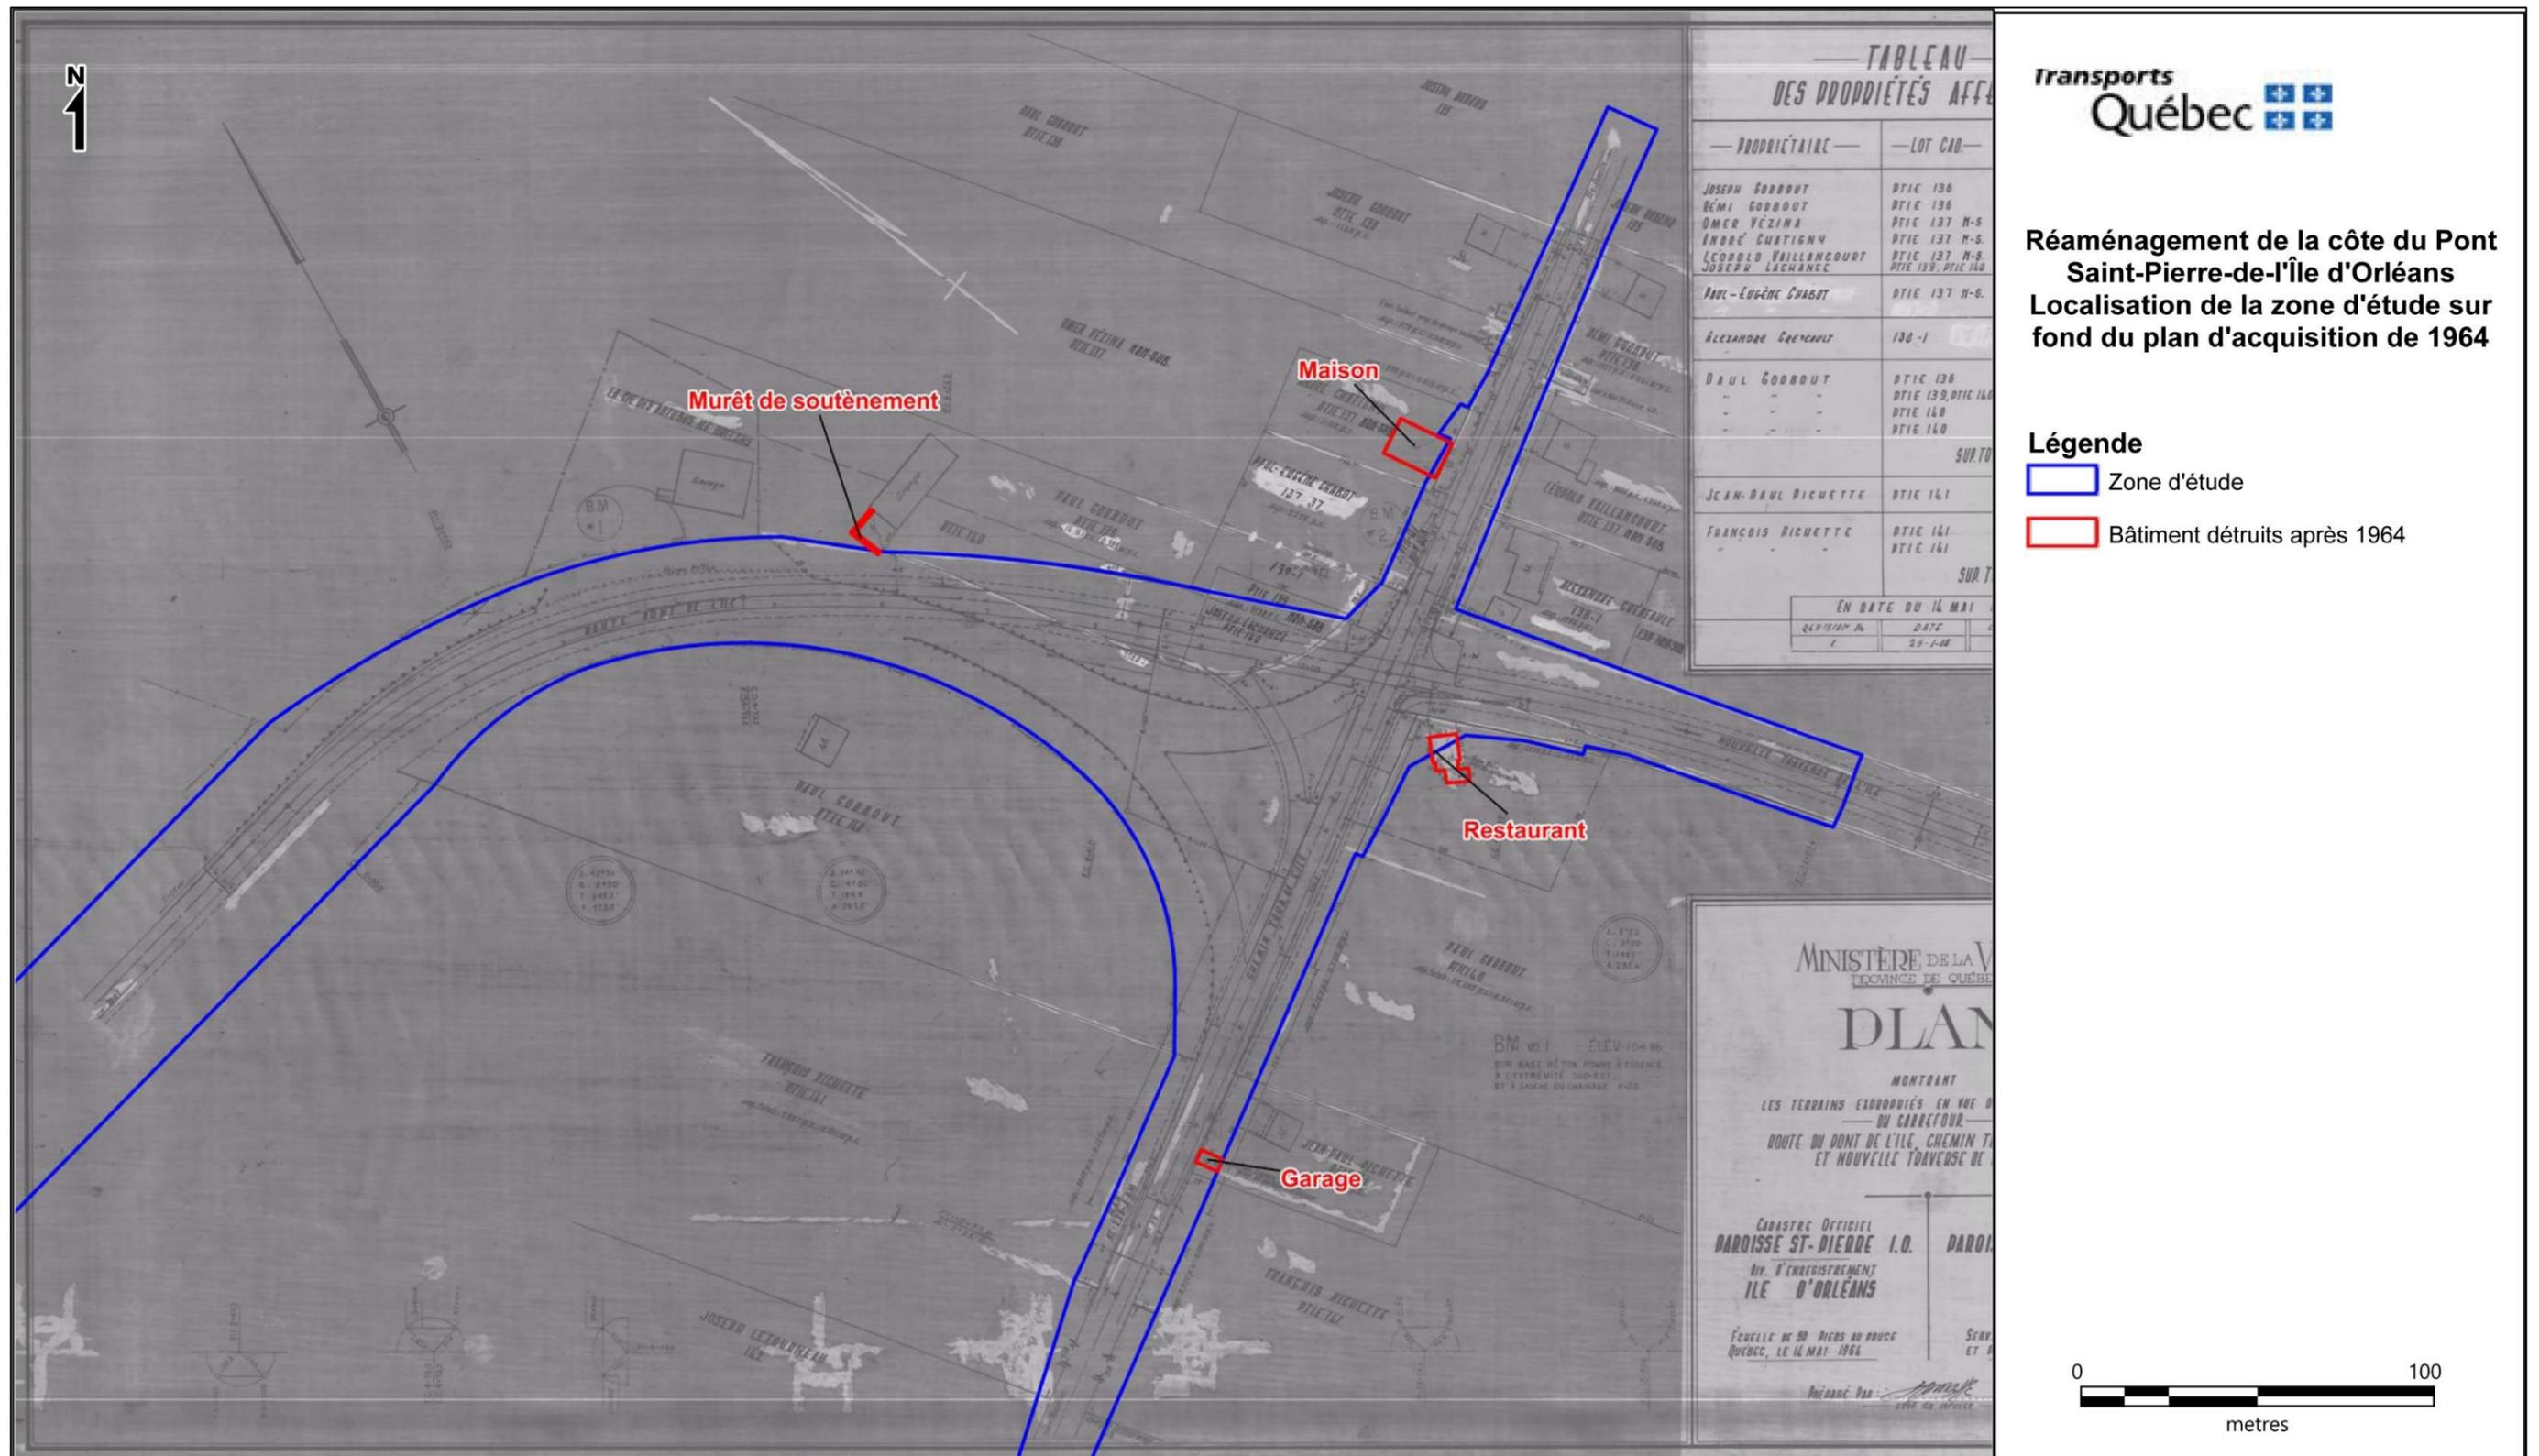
Localisation de la zone d'étude sur plan d'acquisition de 1964 (Source: MIQ, plan 2568M)
